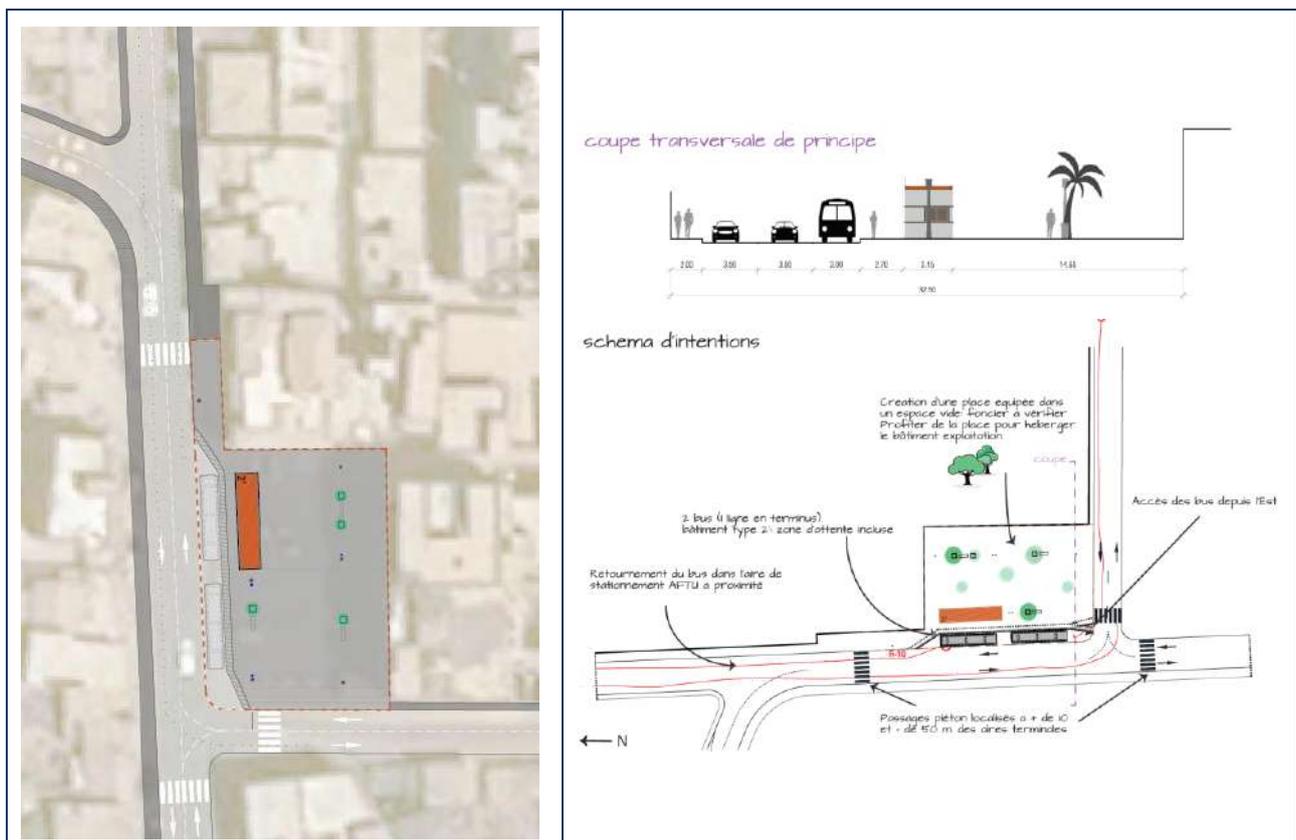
Exemple de plan d'une aire terminale, ici l'aire de Yoff Frigo
